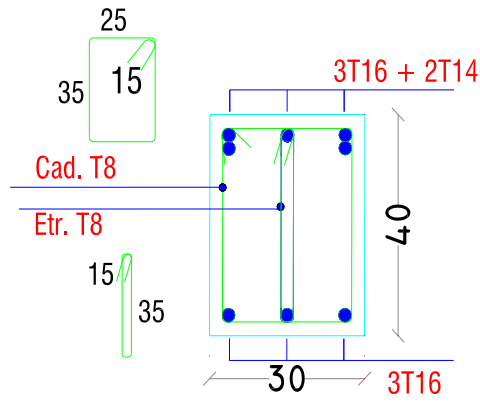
Ferrailage des poutres principales pour Etage 8.
